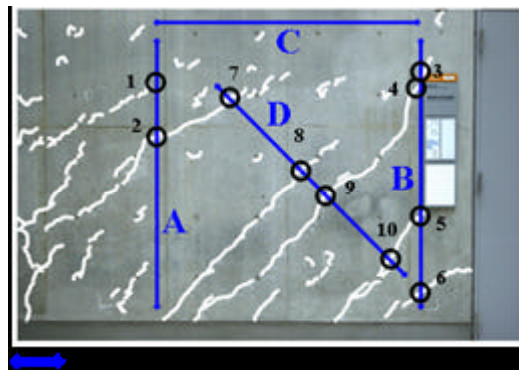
12月のひび割れ状況と計測機器取り付け位置図
